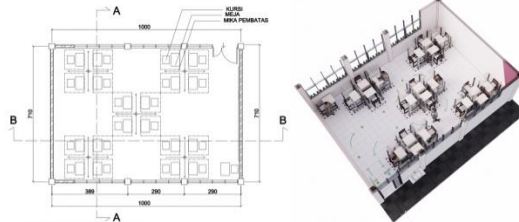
Denah Ruang studio 3-1 tipe Semi Circle
